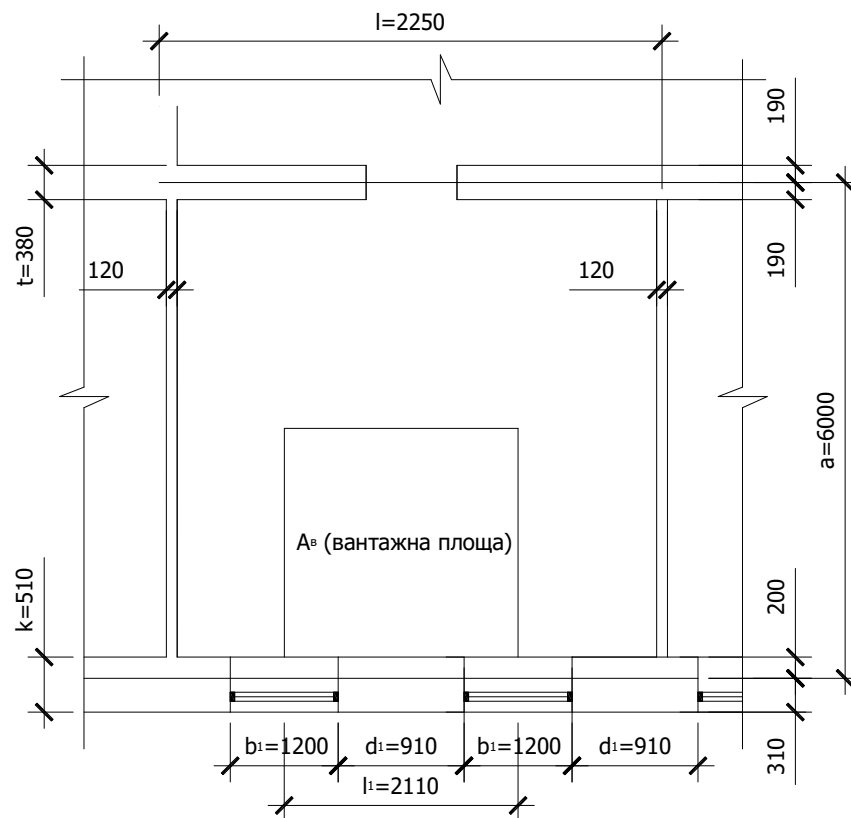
Фрагмент плану другого поверху будівлі
